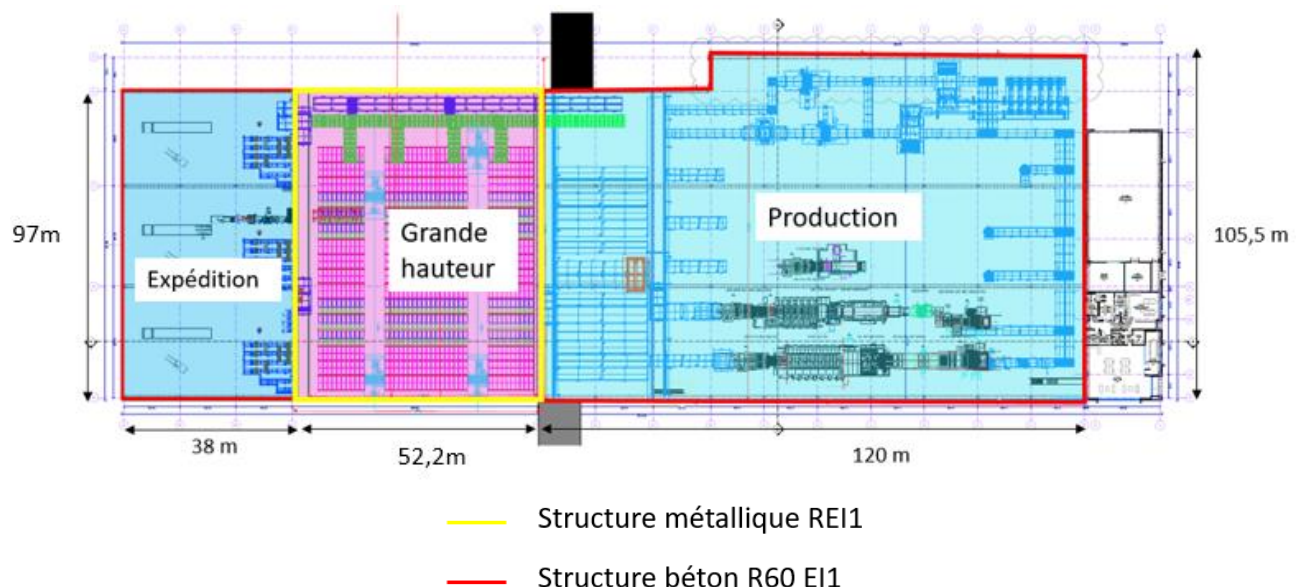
Plan de masse du bâtiment façonnage – identification des zones
